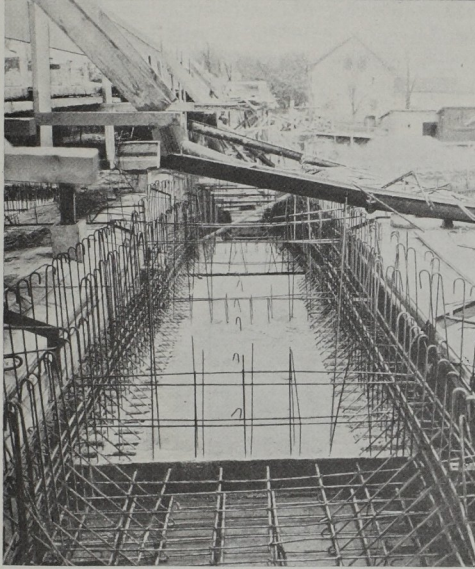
Wandarmierung einer Kastenrippe, Bodenplatte teilweise betoniert
